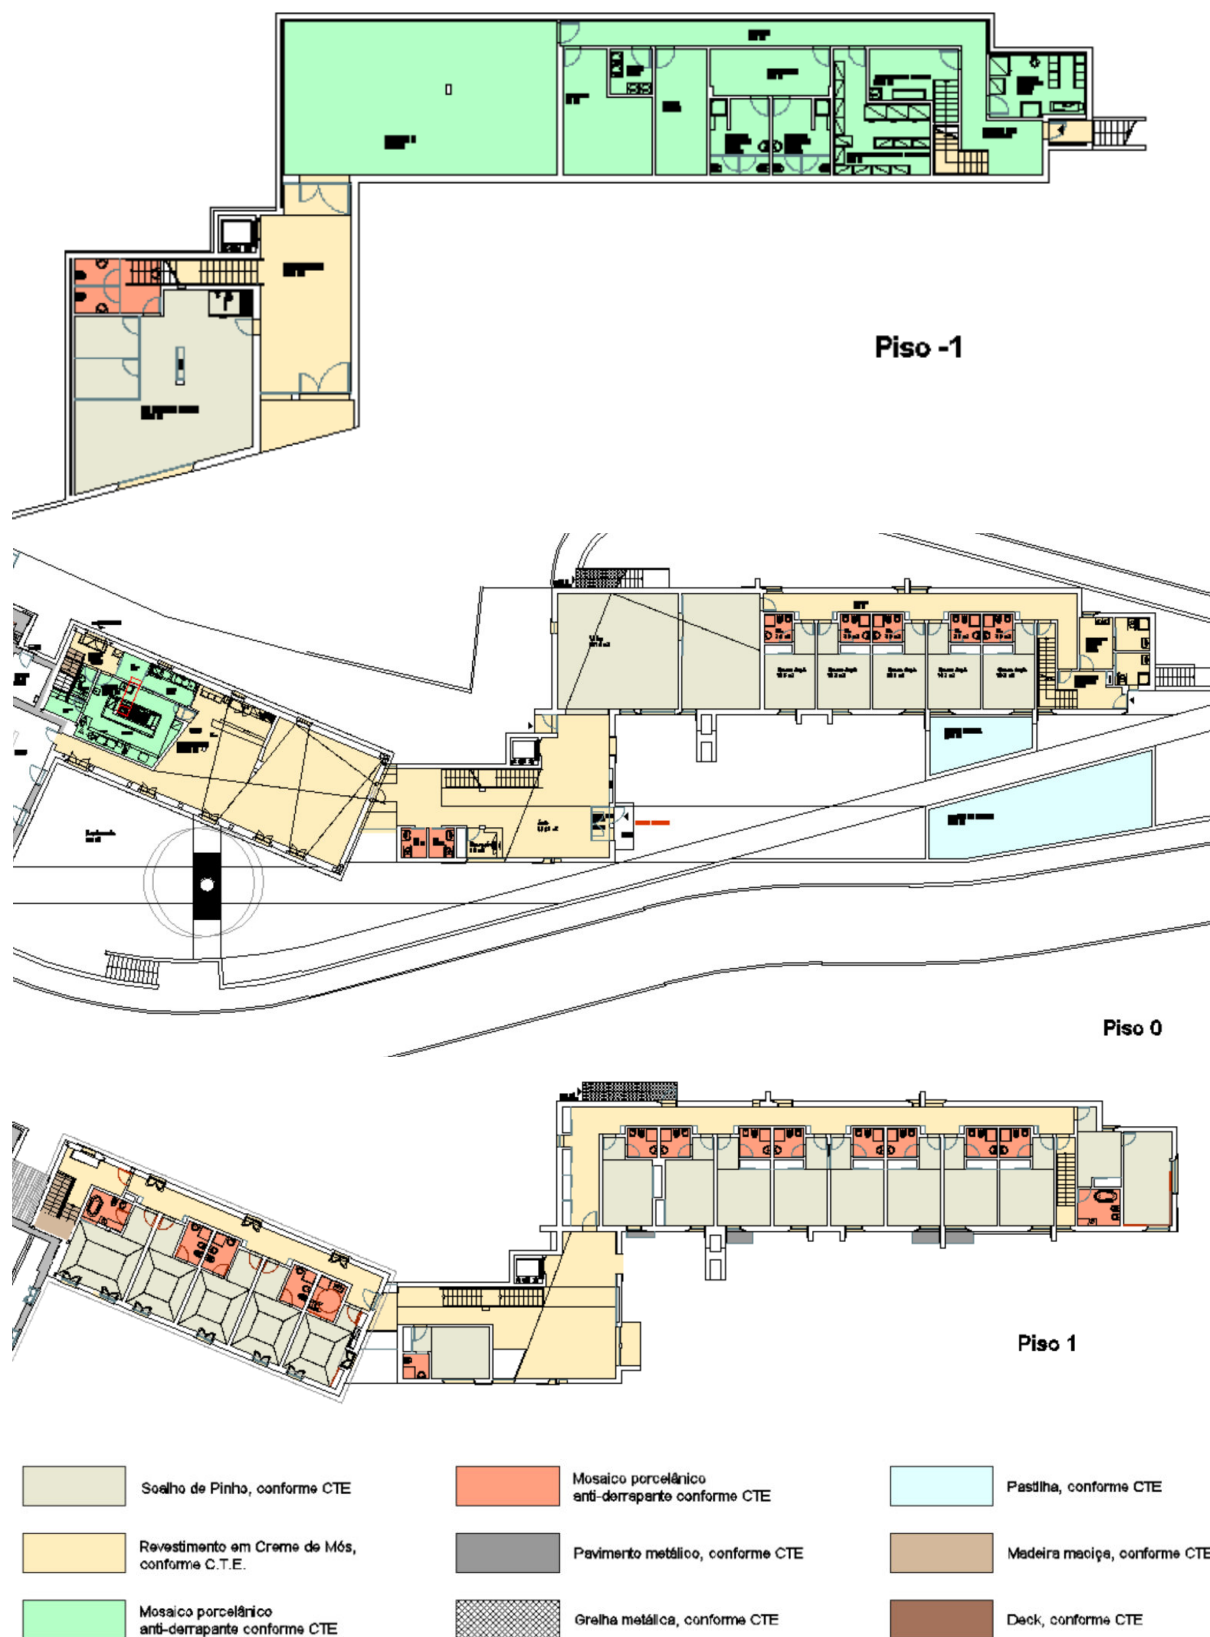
Planta de pavimentos hotel (s/ escala) [26]
